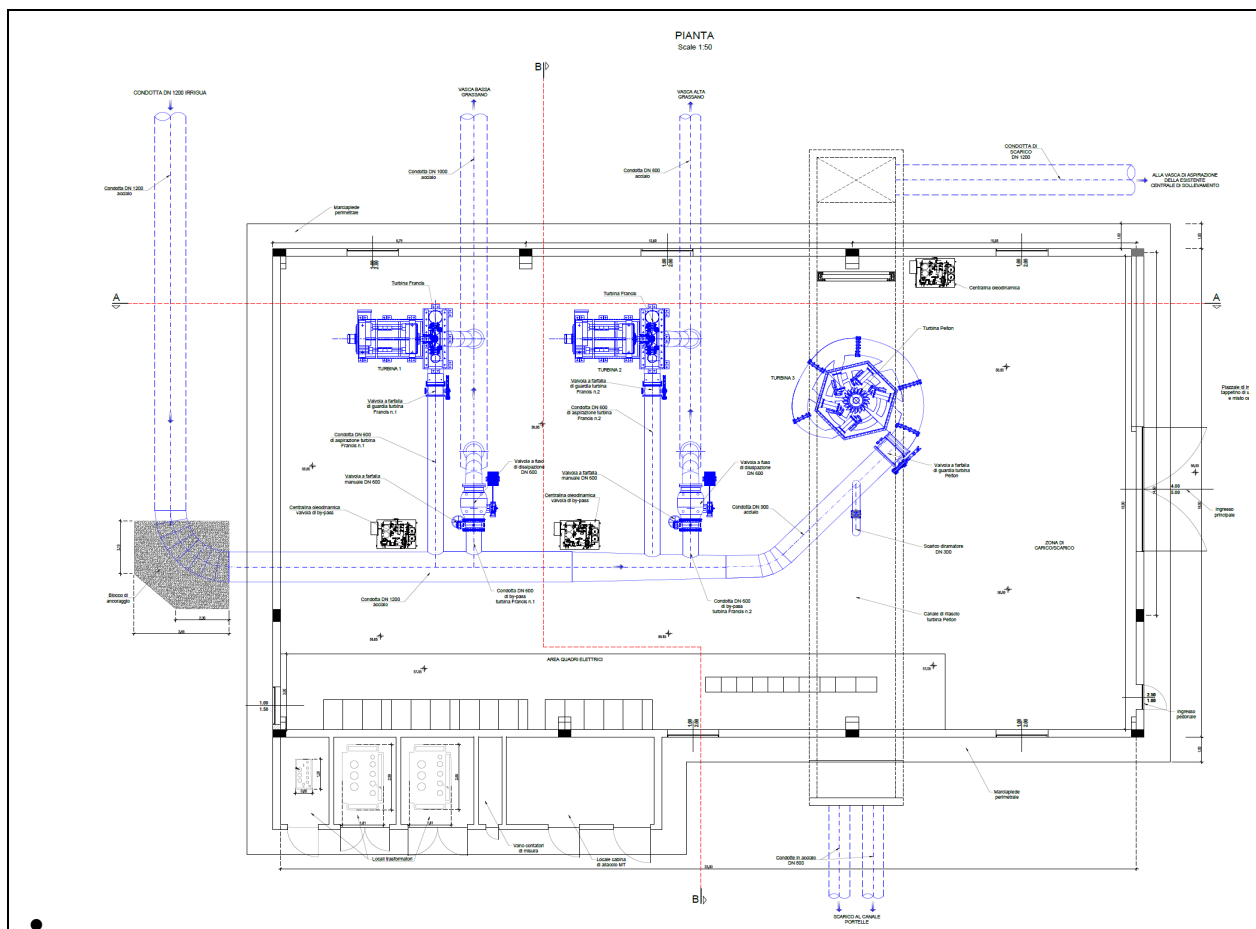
Layout della centrale con le dotazioni idrauliche ed elettromeccaniche installate – elaborato IDI.02.01
